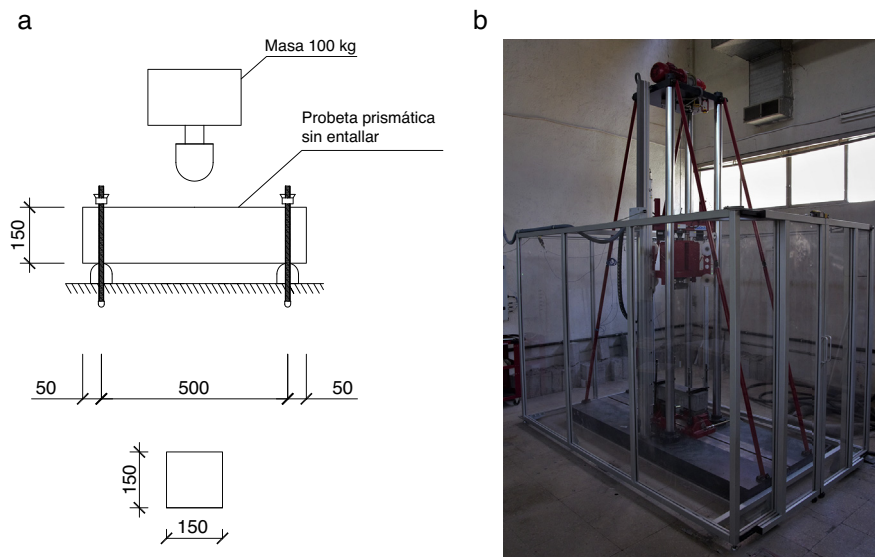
Detalles de los ensayos: a) configuración del ensayo; b) vista general de la máquina de impactos en el laboratorio (dimensiones en milímetros).
